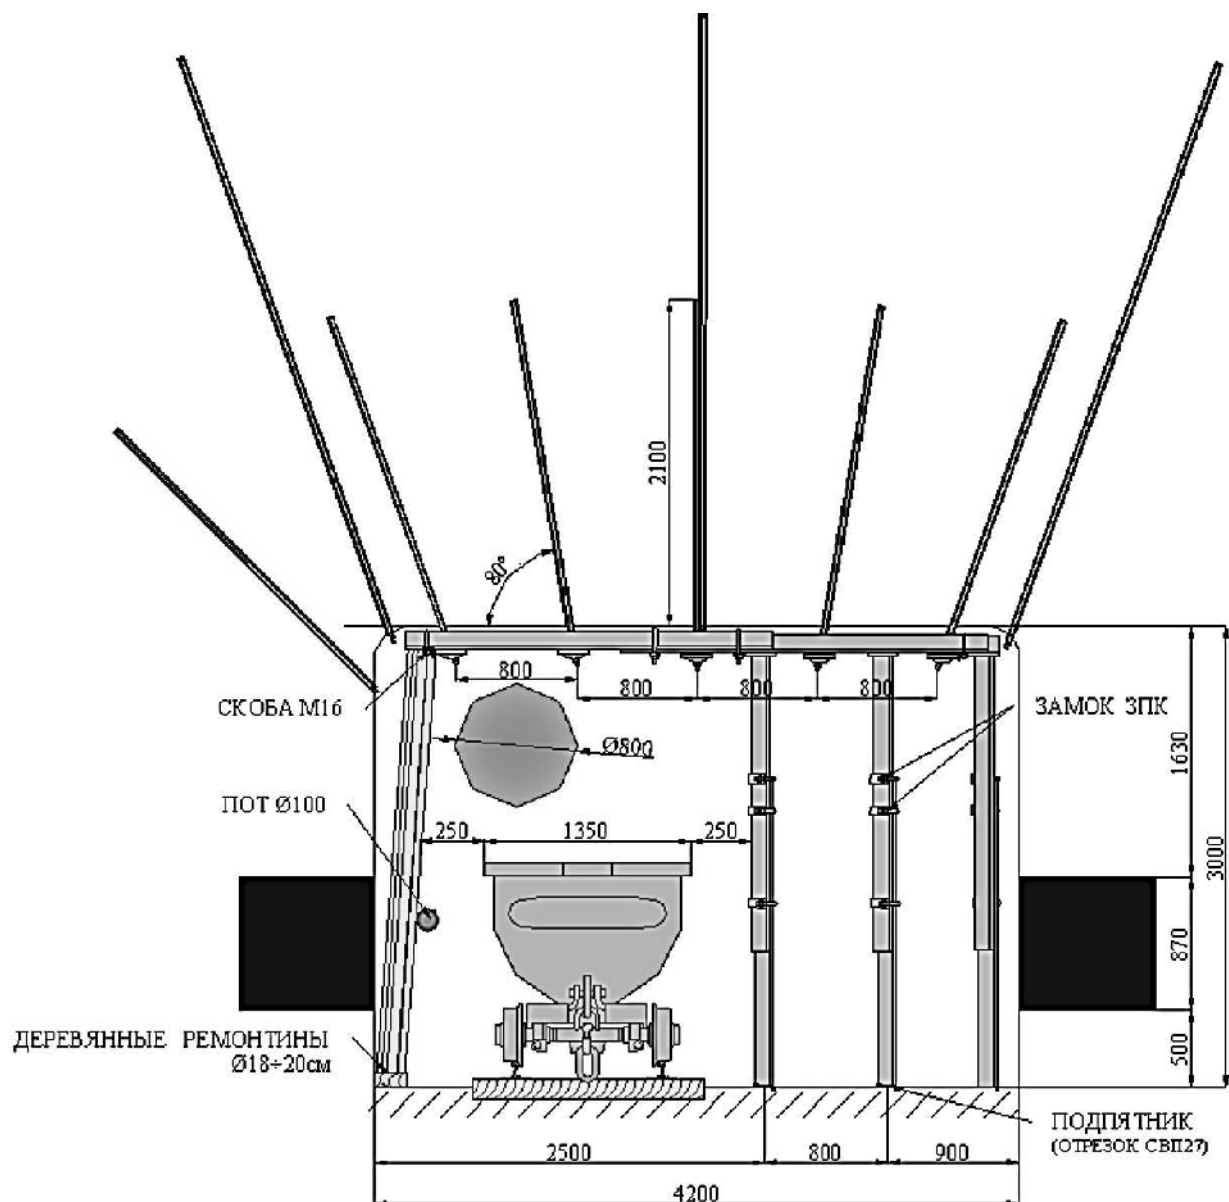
Схема поперечного сечения и конструкции крепи демонтажной камеры 161-й лавы пласта С₆
